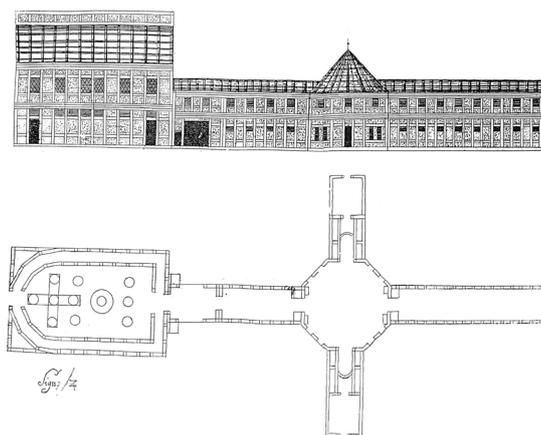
Ansicht und Grundriss des Hauptgebäudes im Mertzelbach 1697, links das Concordienhaus. (Quelle: *Bau-Lust* 1798, Tl. 7, Nr. 3)
